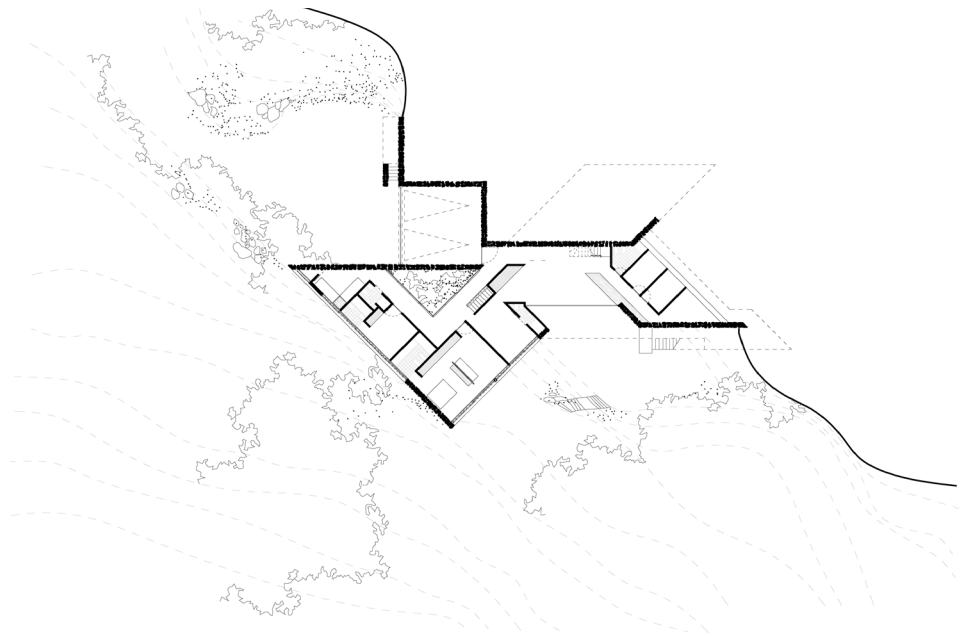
Bonet, casa Rubio planta acceso. Imagen: elaboración propia (CAIT).
